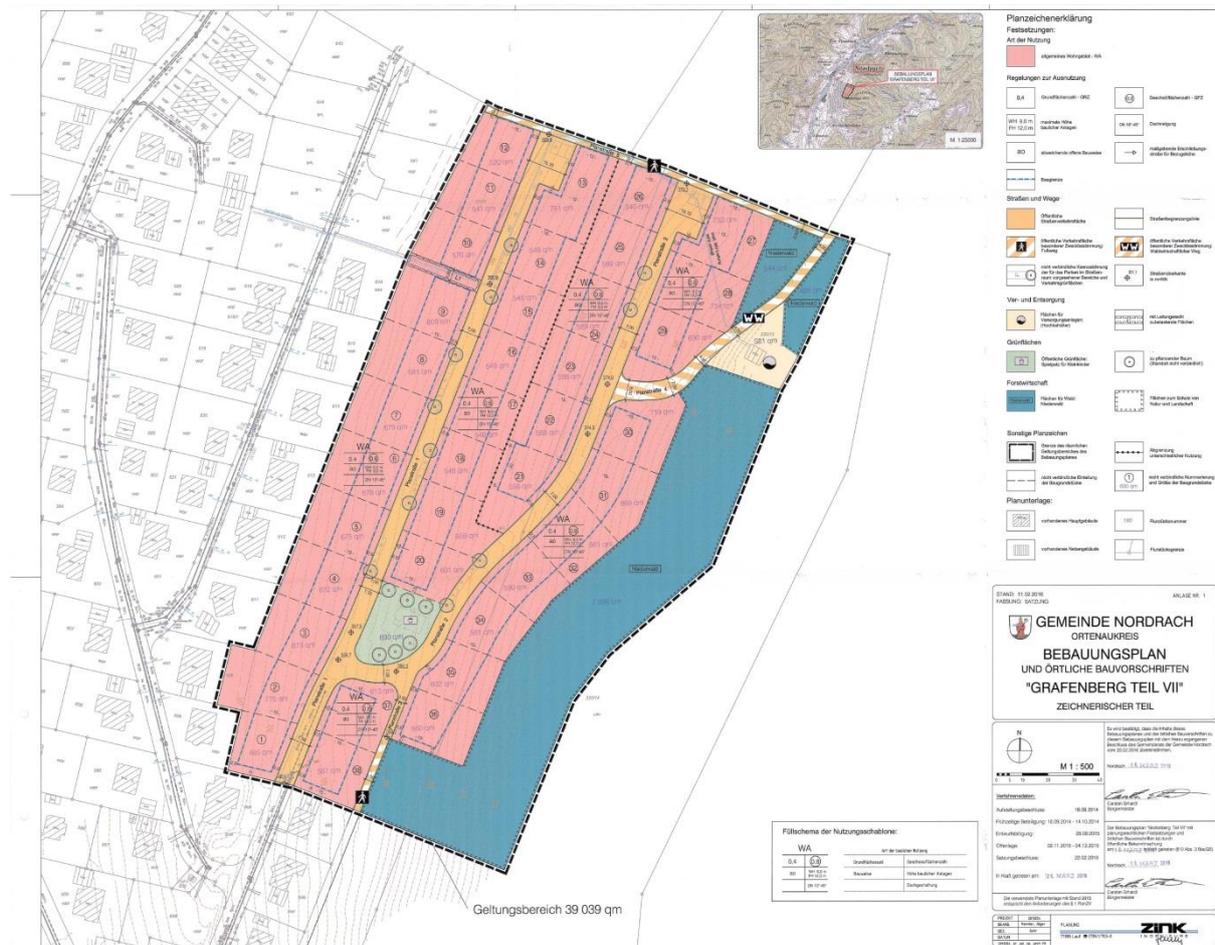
Planzeichnung des Bebauungsplans „Grafenberg Teil VII“, rechtsverbindlich seit dem 25.03.2016
